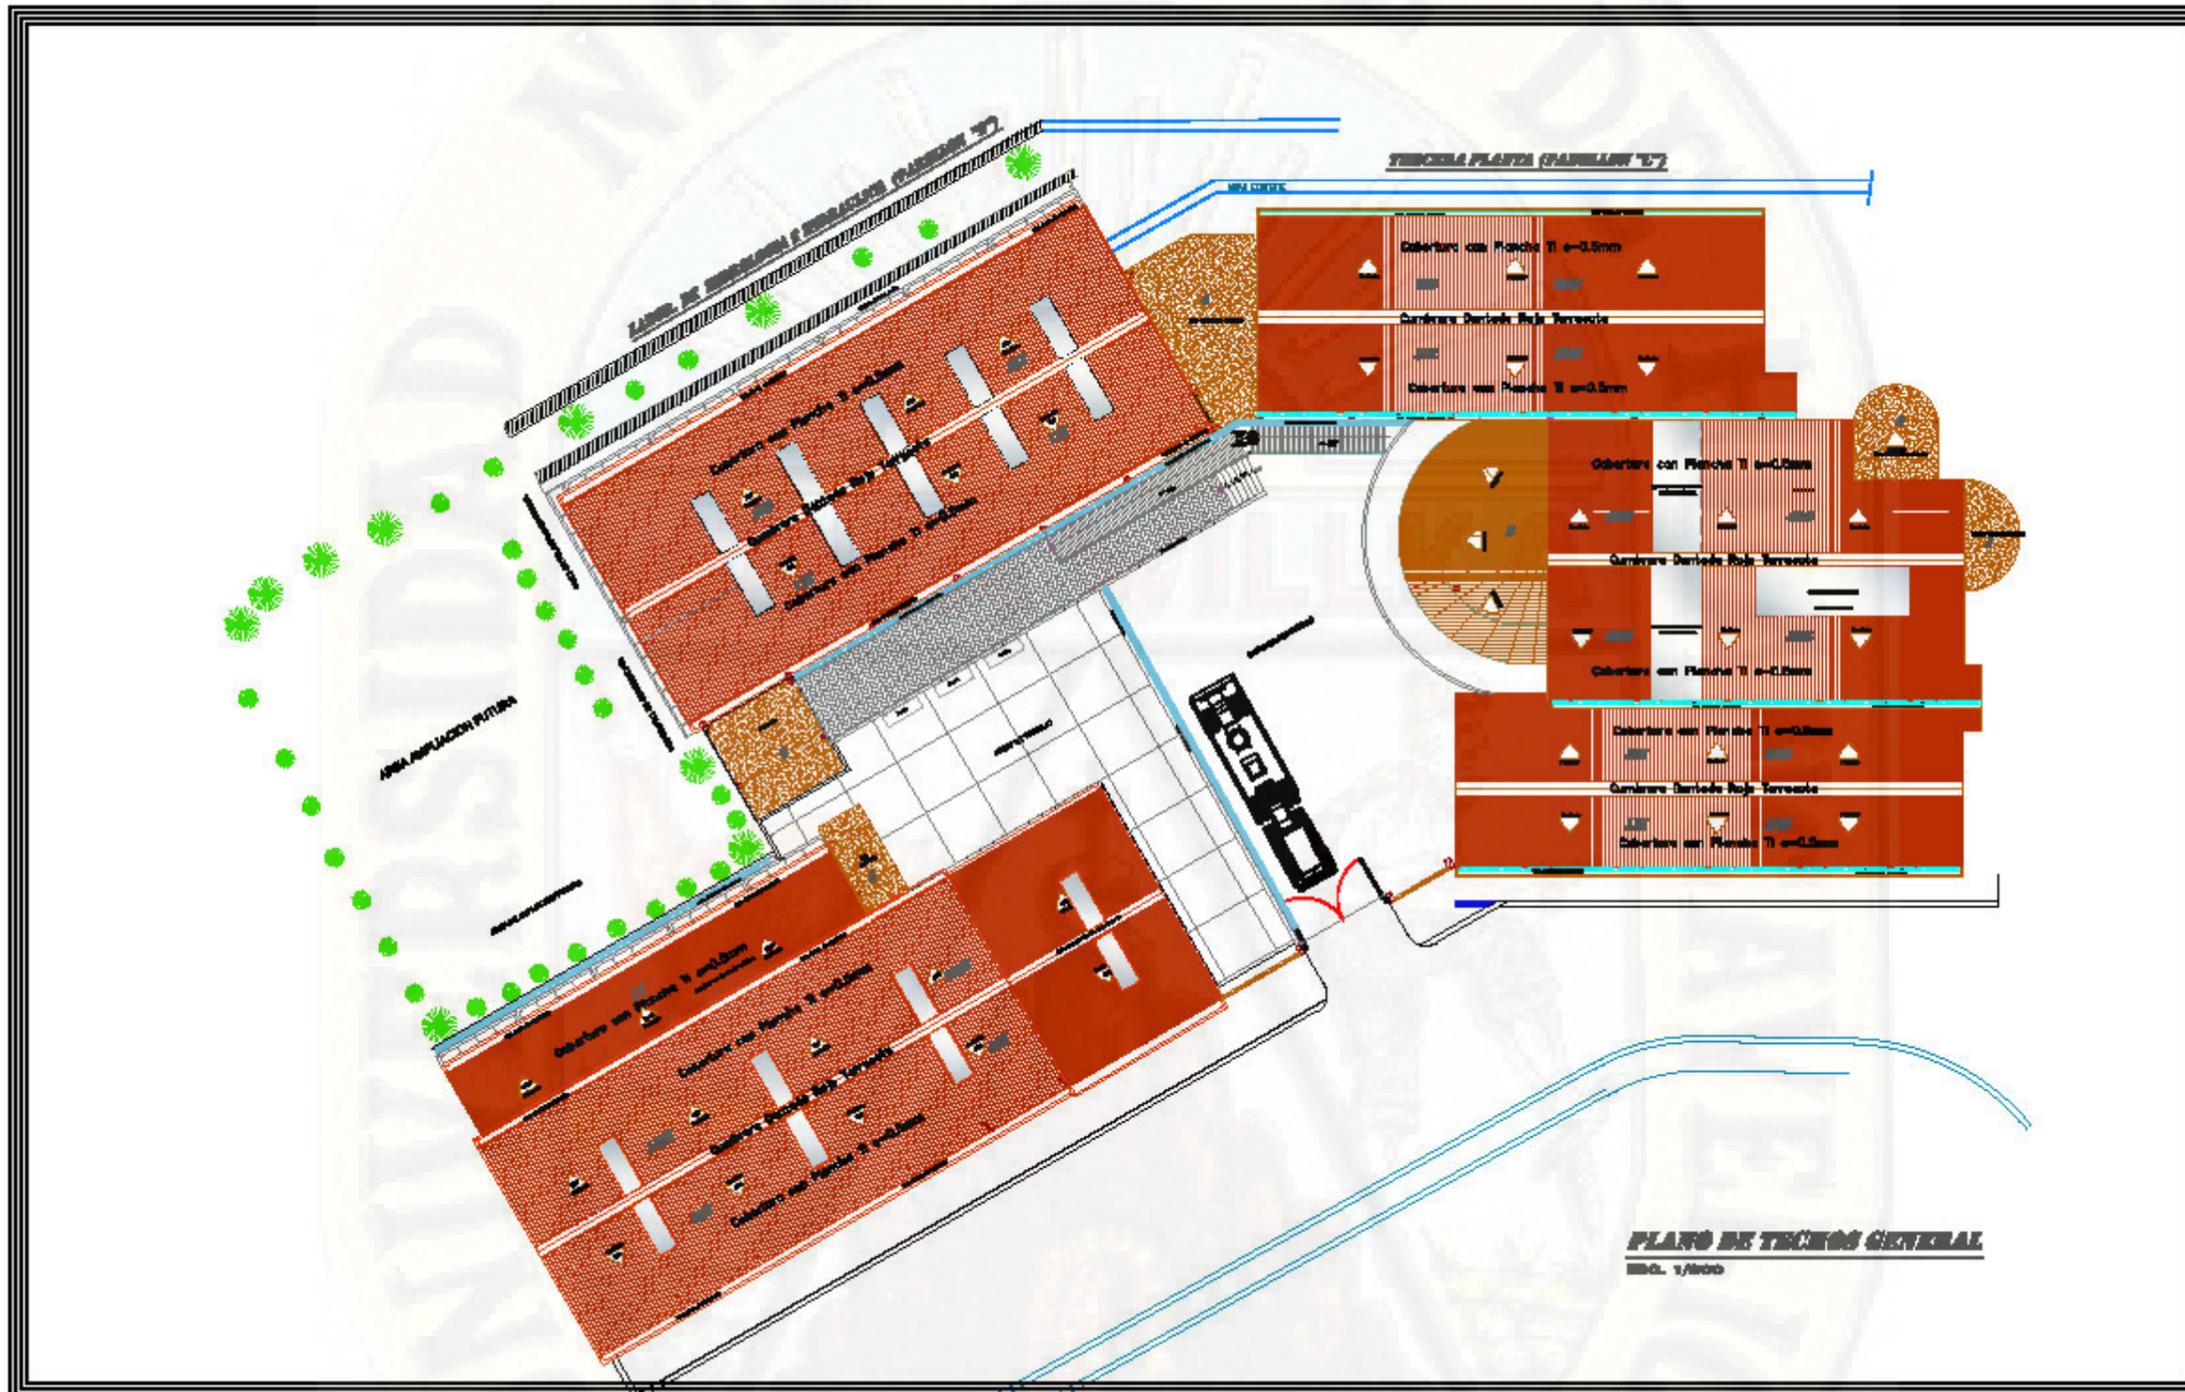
NUMERACIÓN DE ELEMENTOS (COBERTURAS) PLANTA
